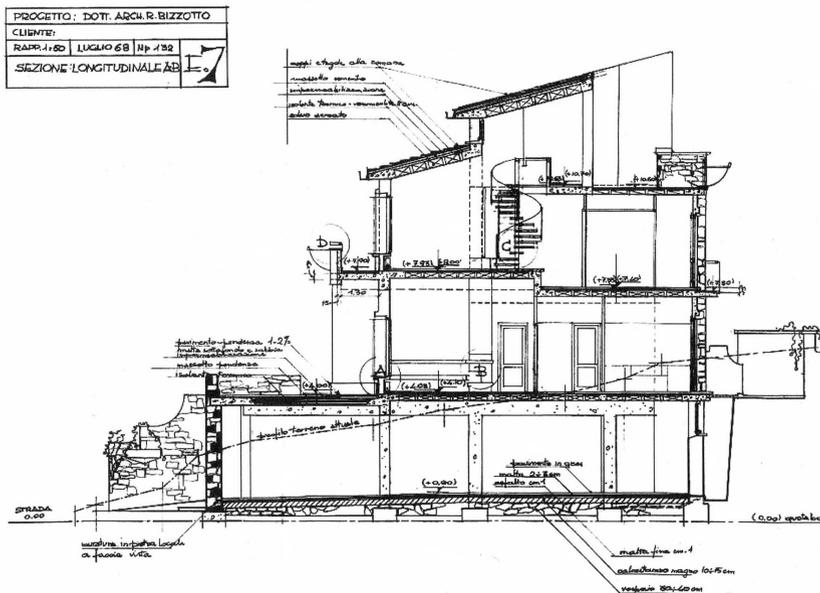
Sezione longitudinale della villa Di Raimo a Sperlonga, 1968. (fonte: Archivio di Renata Bizzotto).
